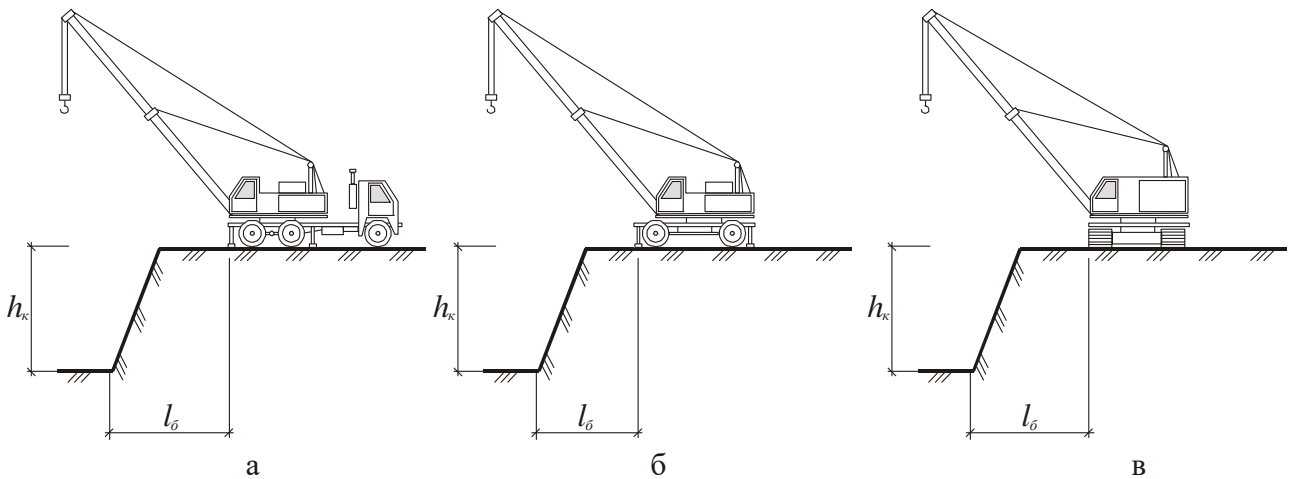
Схема розташування самохідних стрілових кранів поблизу котлованів: а) автомобільний кран; б) пневмоколісний кран на спецшасі; в) гусеничний кран; l_{δ} – безпечна відстань найближчої опори крану до краю дна котловану, м; h_{κ} – глибина котловану, м
